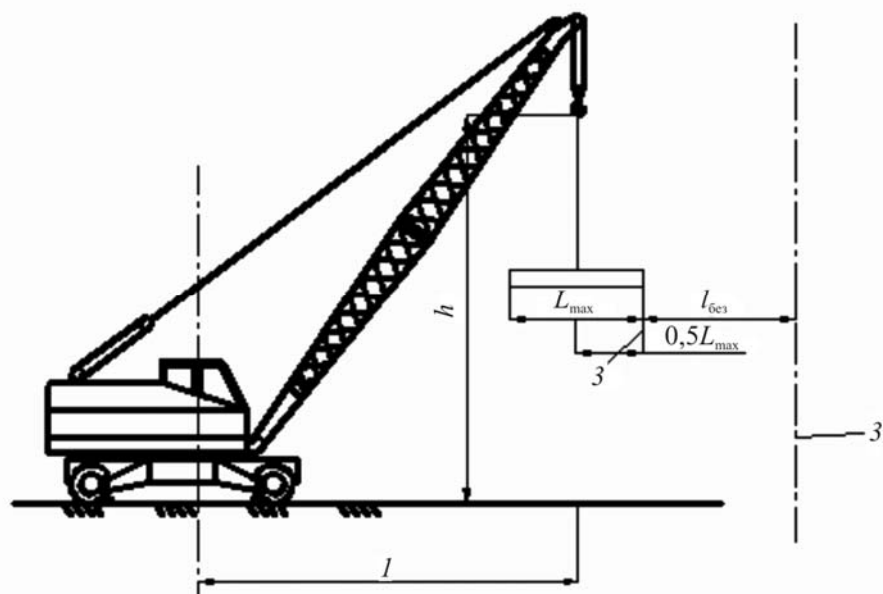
Определение необходимых зон при работе самоходных кранов, снабженных устройством, удерживающим стрелу от падения: *1* — граница зоны обслуживания; *2* — граница зоны перемещения груза; *3* — граница опасной зоны
